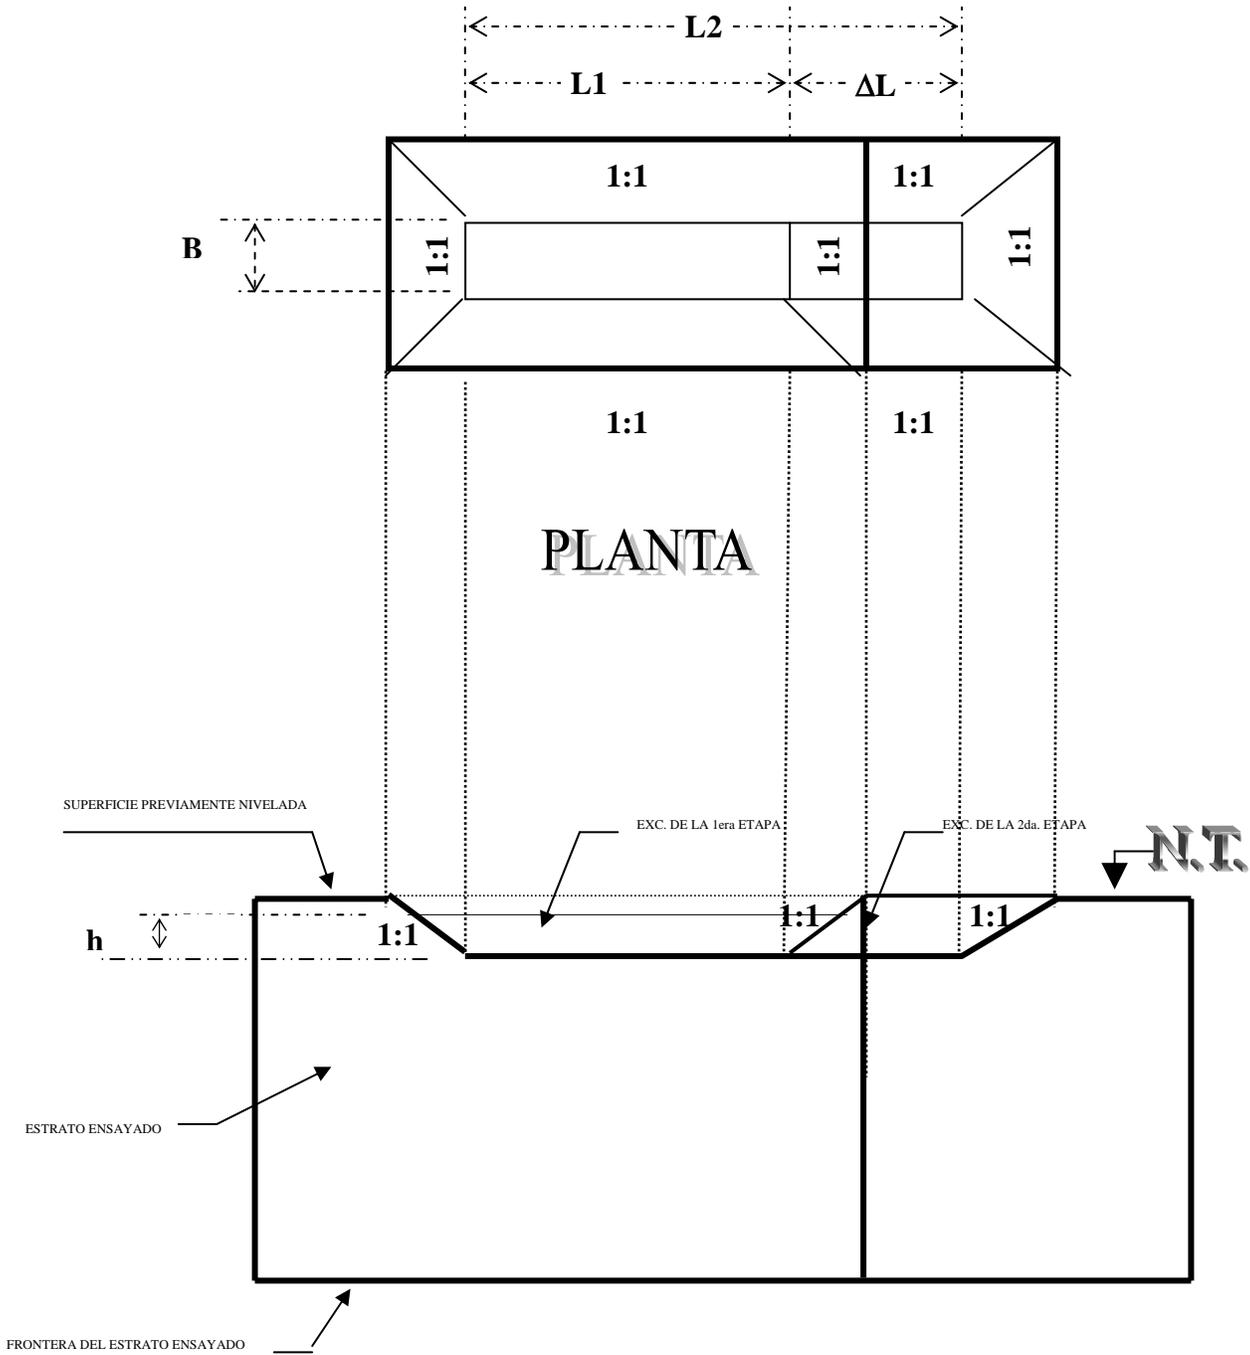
Geometría de la zanja de la prueba Matsuo Akai, para ambas etapas de la prueba
